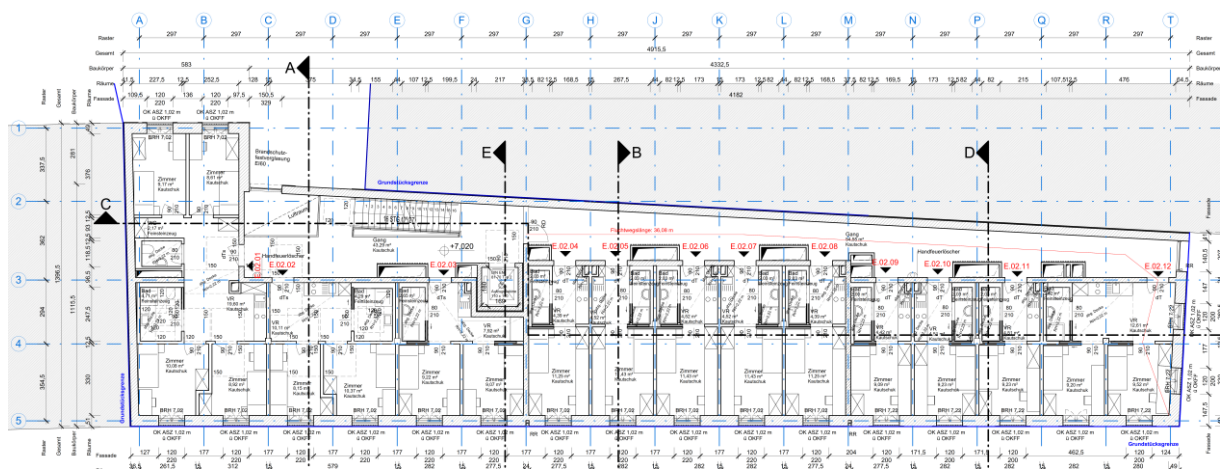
Exemplarischer Grundriss (Regelgeschoss 1.-3.OG)
